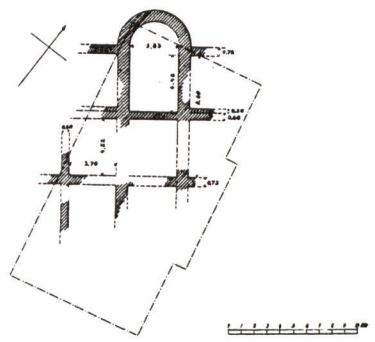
Aalen, Gebäude unter der Leichenhalle.
